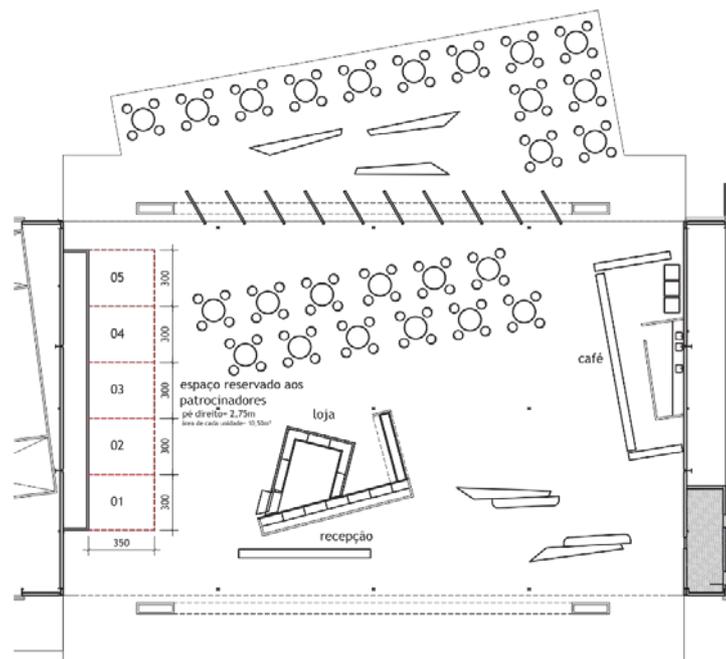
, 33 e 34: Planta baixa, corte e esquema perspectivo indicando núcleos curatoriais da mostra Conversas Armazém A4
